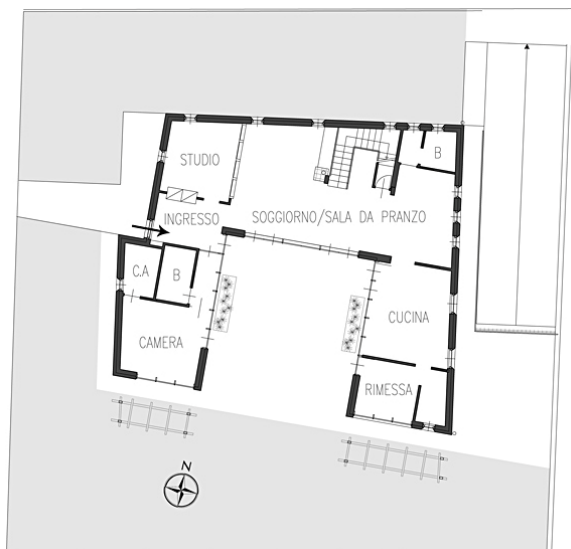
Planimetria piano terra [studioroatta.it].
